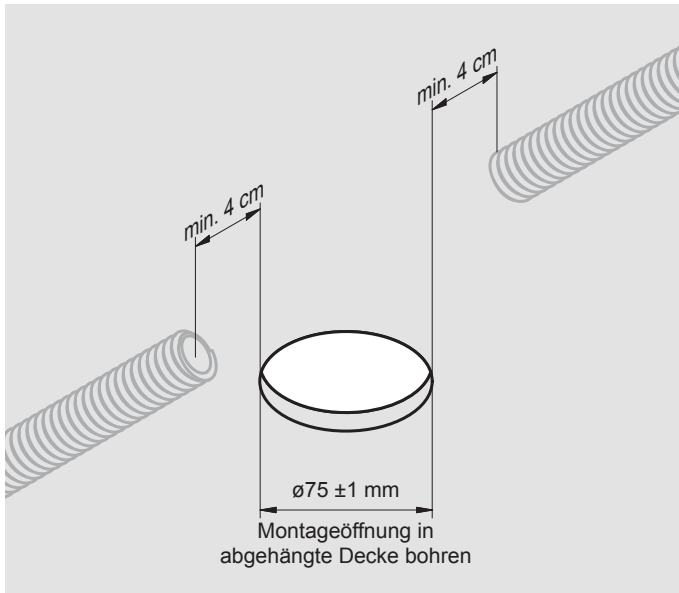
Montageöffnung in die abgehängten Decken bohren
